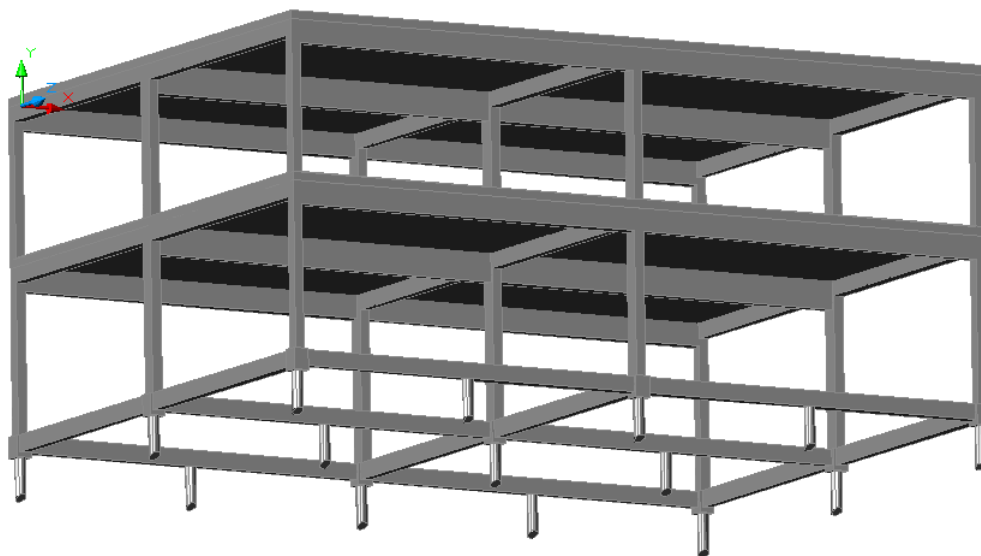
Sistema estrutural tradicional composto por lajes, vigas e pilares.
